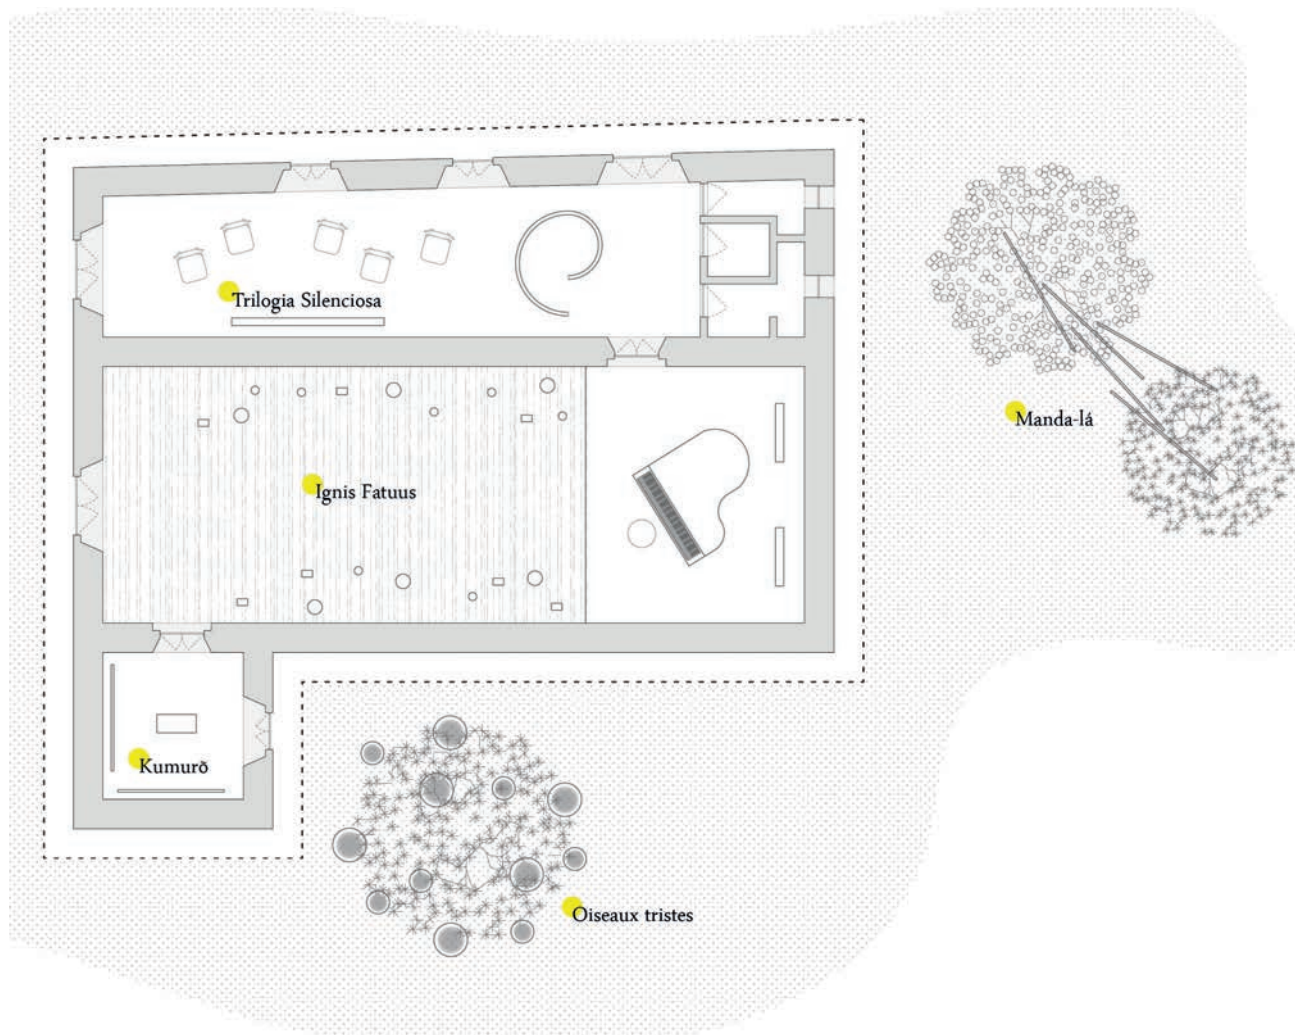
Planta da Capela do Morumbi com a localização das instalações
